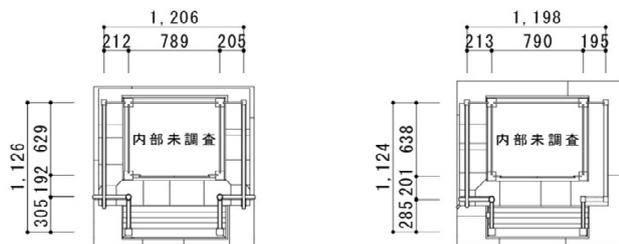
三宮八幡神社小社 (向かって左)、同 (向かって右) 平面図 1/50
